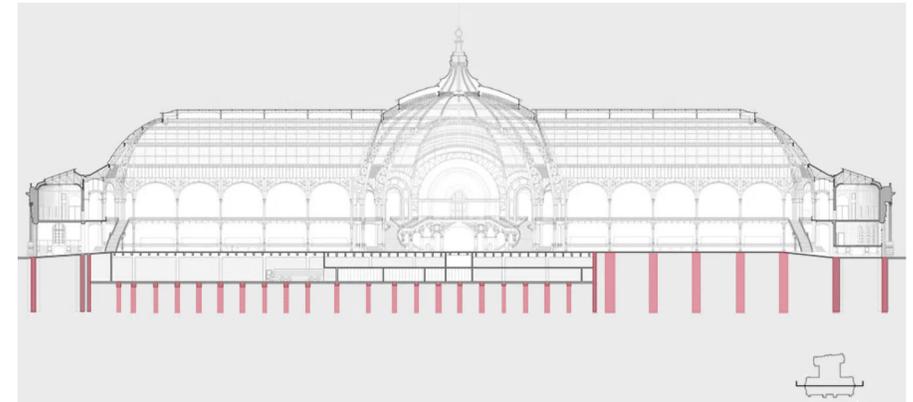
Sección longitudinal y sistema de cimentación destacado en rojo.
